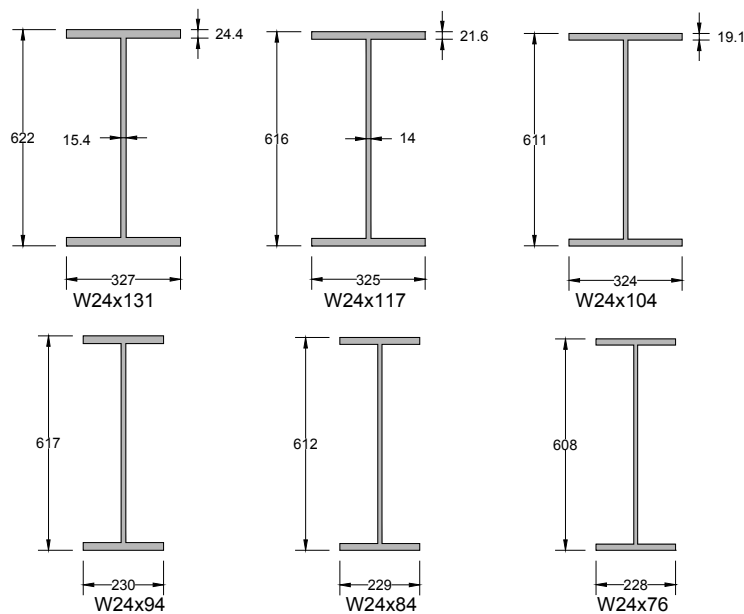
Secciones Transversales Vigas en Sistema de Contravientos
